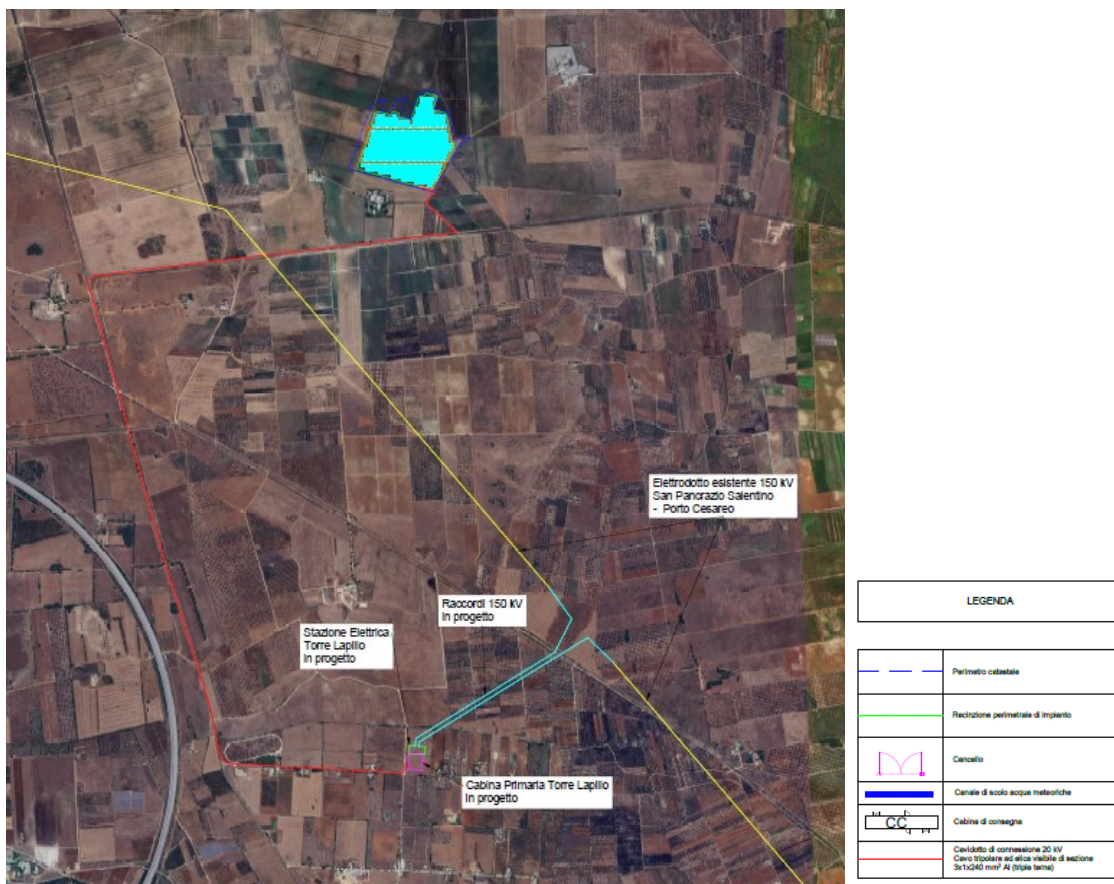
Elaborato TAV 04. Dettaglio: layout generale cavidotto di connessione su ortofoto.
